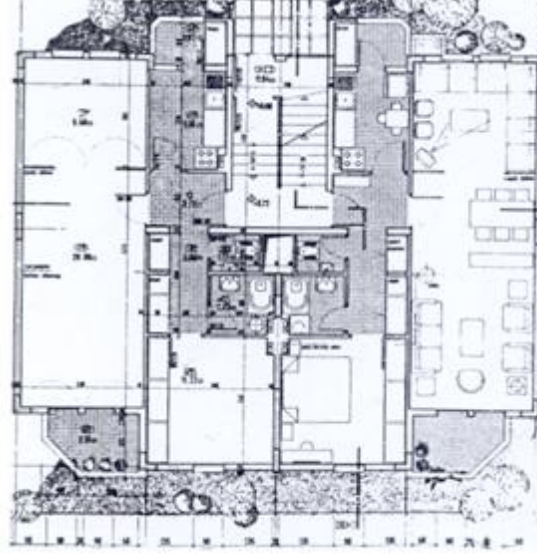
Vaziyet planı (Birkan, 1982)
